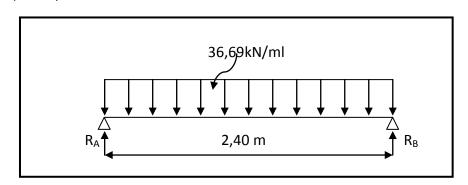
Schéma statique de la poutre palière à l'ELU.
